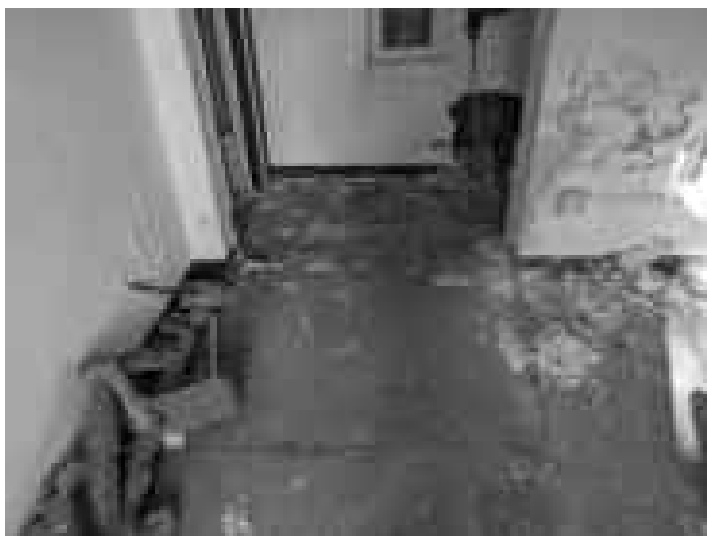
Posizione indagini V3 – Spalle all'ingresso
